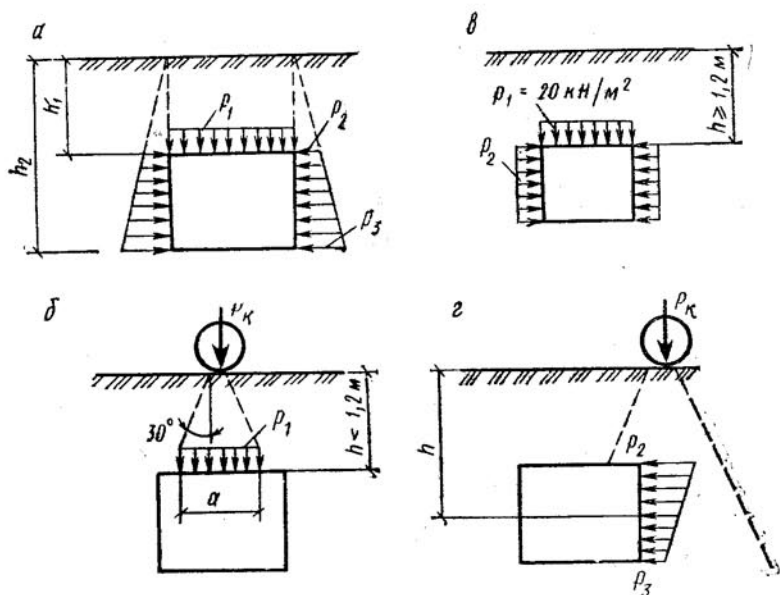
Схемы нагрузок на подземные каналы и туннели
